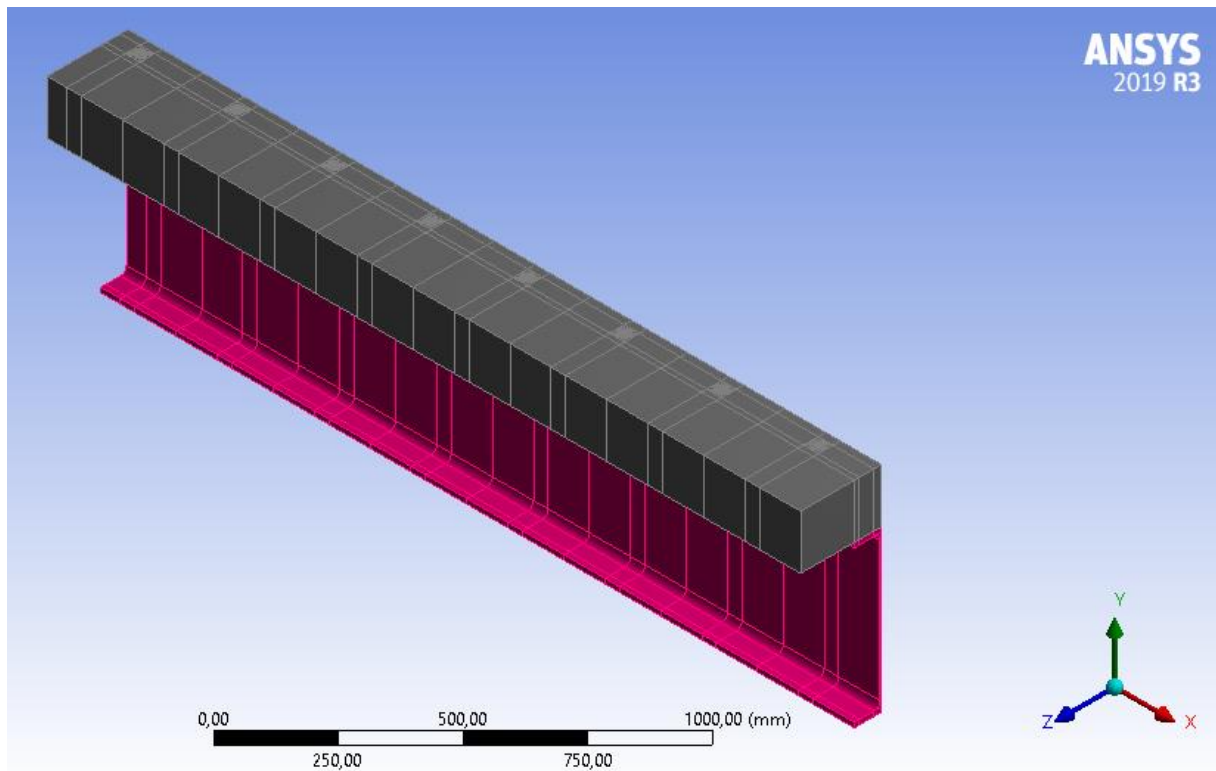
Aplicação automática da condição de dupla simetria da viga mista no ANSYS.
